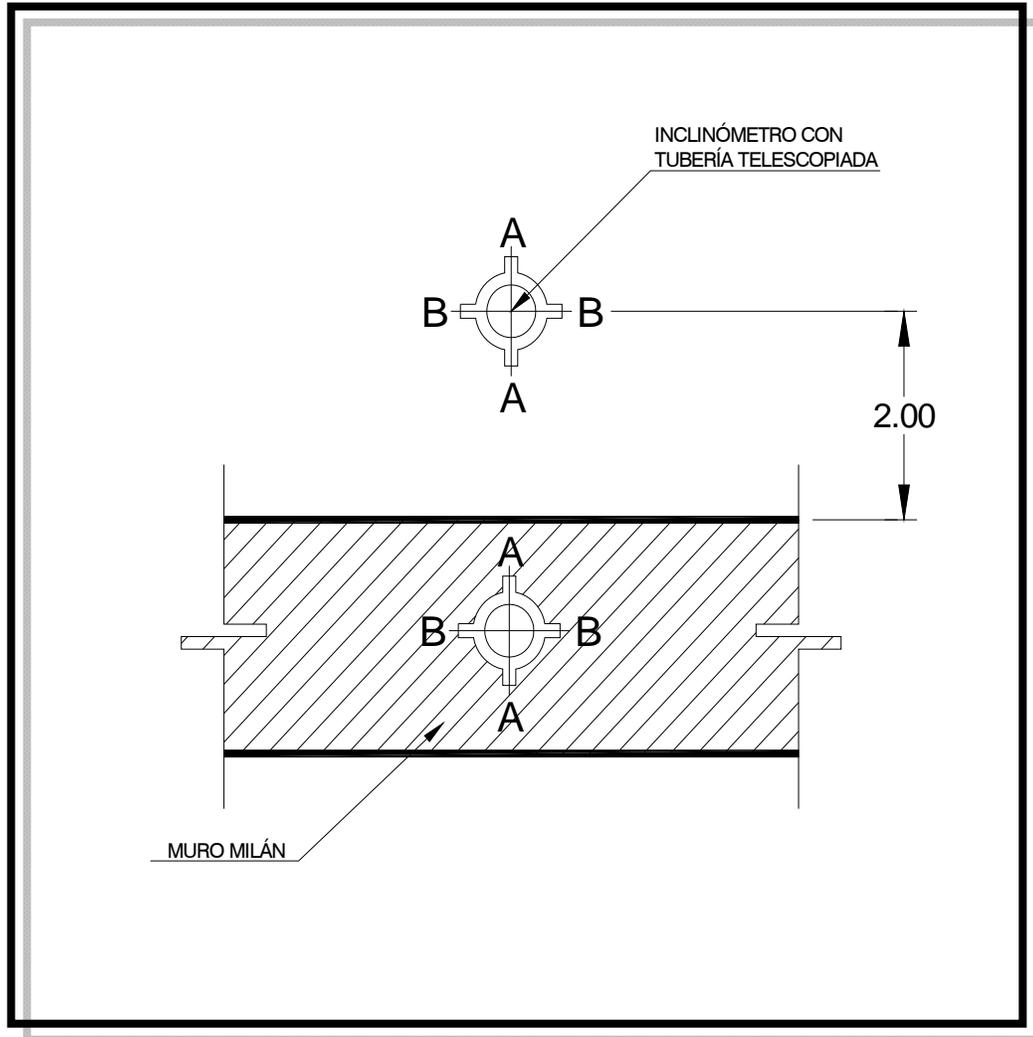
Instalación de tubería de pvc en armado de parrilla de muro milán
